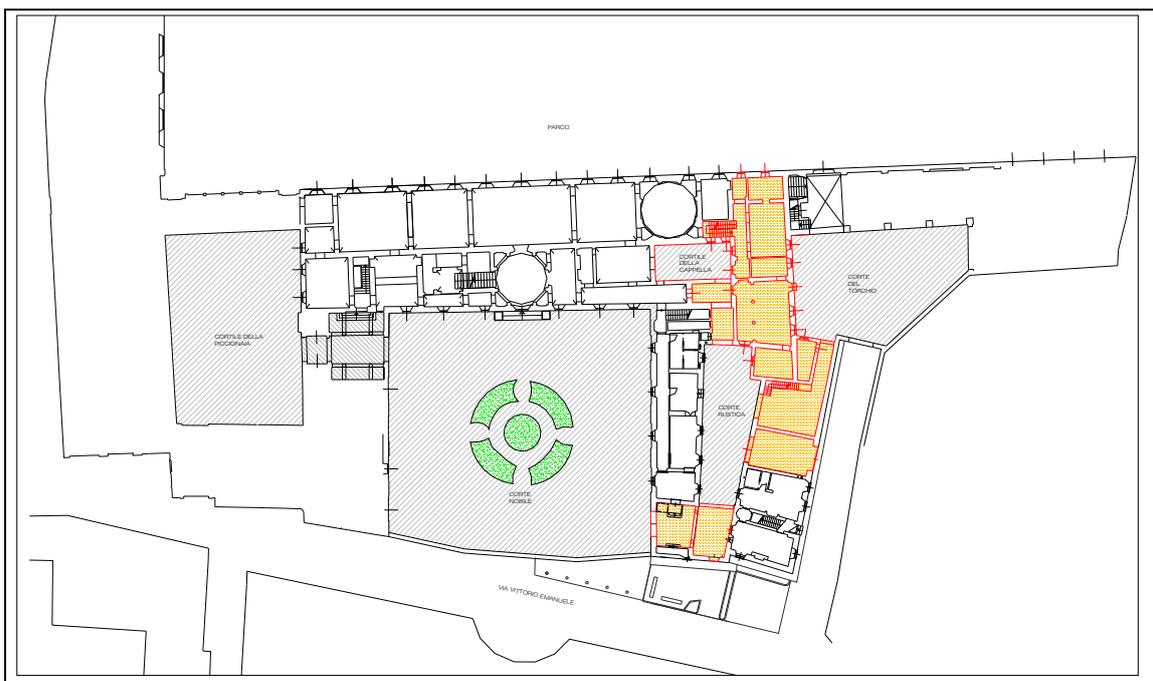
Corpo di fabbrica oggetto d'intervento (Il lotto).
